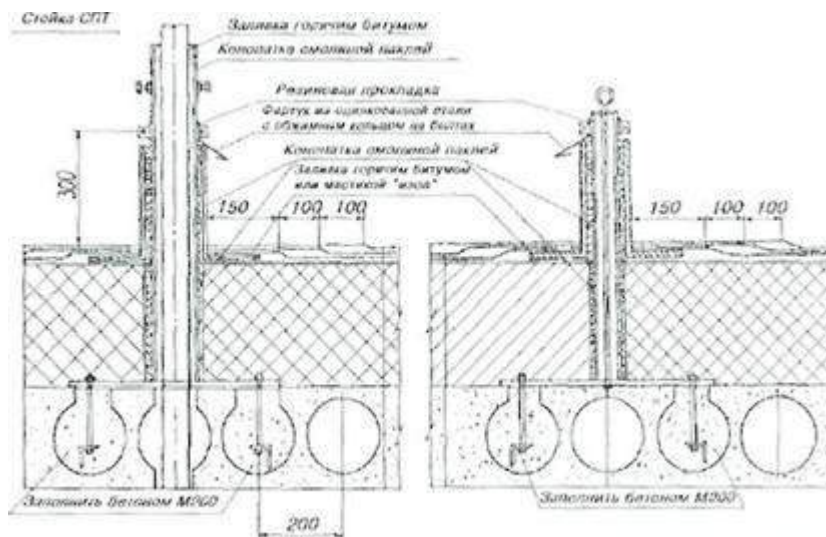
Конструкция примыкания кровли к опорной гильзе и к анкеру.
